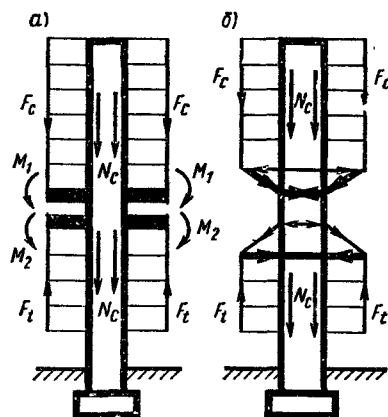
Конструктивные схемы комбинированных одноствольных зданий с подвешенными этажами
